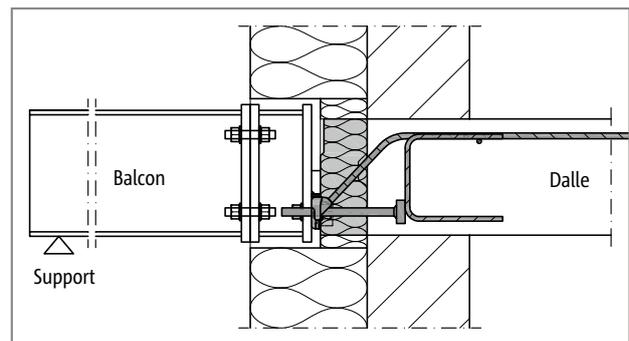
Schöck Isokorb® T type SQ : Raccordement de la poutre en acier à un adaptateur compensant l'épaisseur de l'isolation externe
